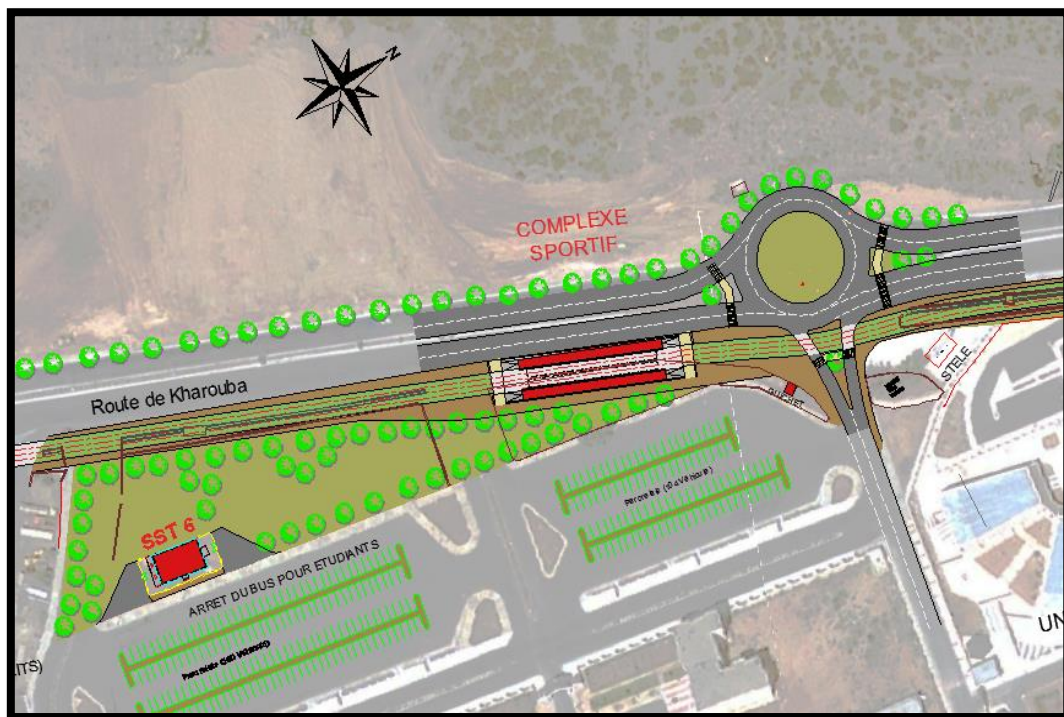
l'intersection entre la route kharouba et ben yahia belkacem
